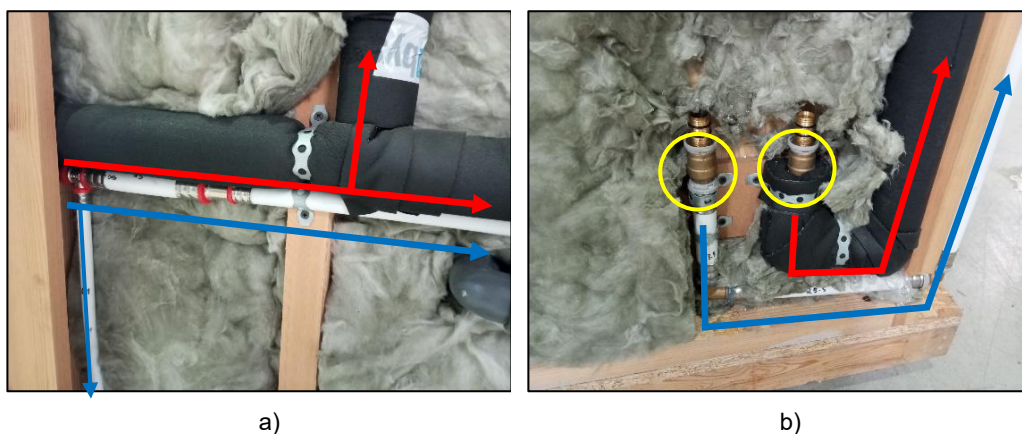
Redes de abastecimento de água fria (setas azuis) e água quente (setas vermelhas) do POD de Casa de Banho, vistas pelo exterior, formadas por tubagem multicamada de PE/Al/PEX-b encastradas e fixas à estrutura de madeira: (a) Pormenor da instalação das redes, com a tubagem da rede de água quente isolada termicamente com espuma elastomérica; e (b) Extremos de montante das redes, com válvulas de seccionamento (círculos amarelos).
